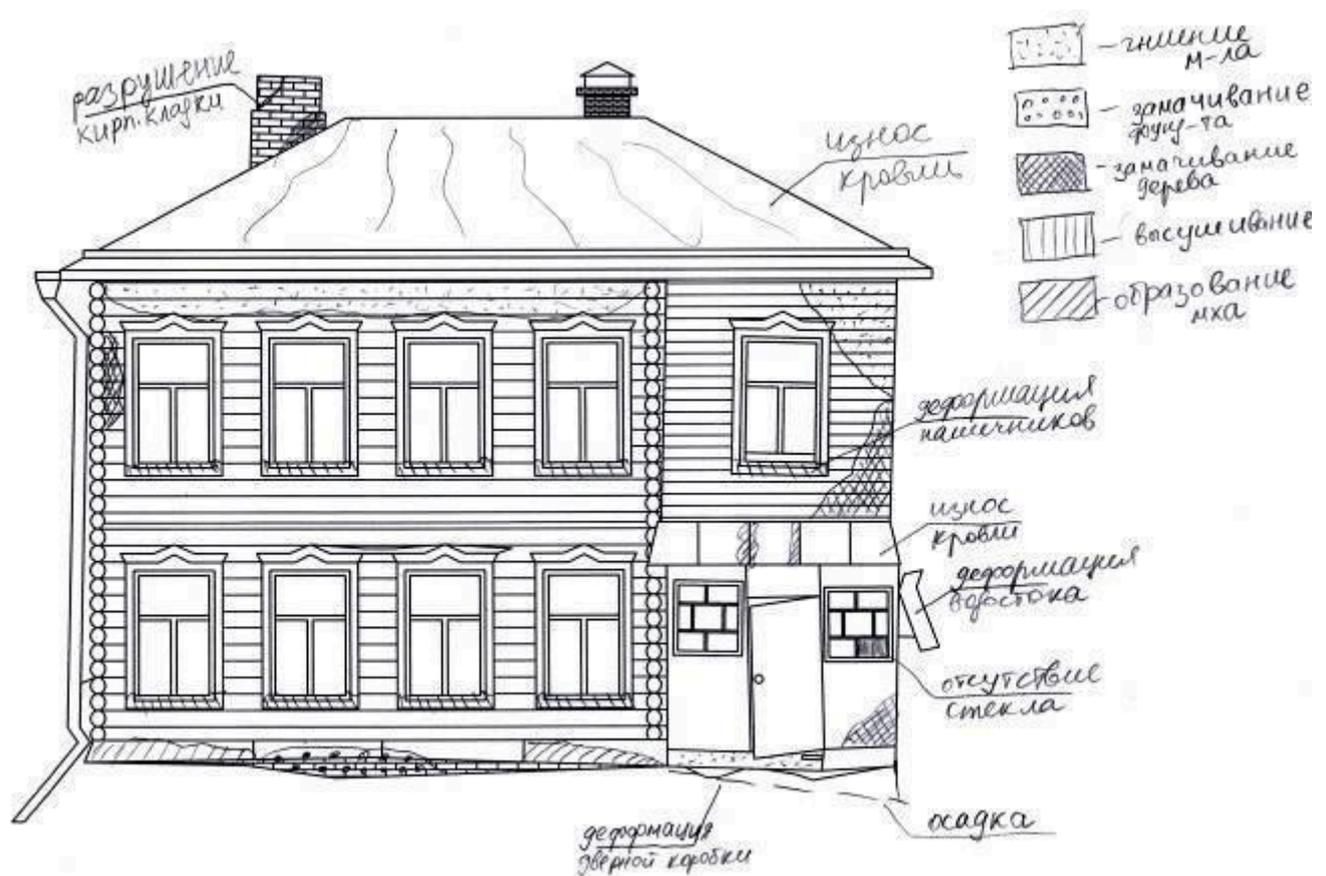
Дефектная карта фасада деревянного здания (пример)
